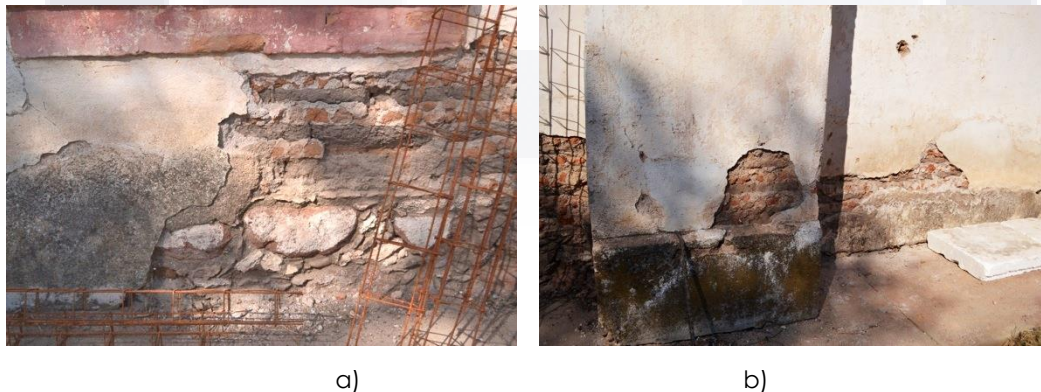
Detalle de la disposición de la piedra e intervenciones posteriores a su construcción con tabique rojo.
